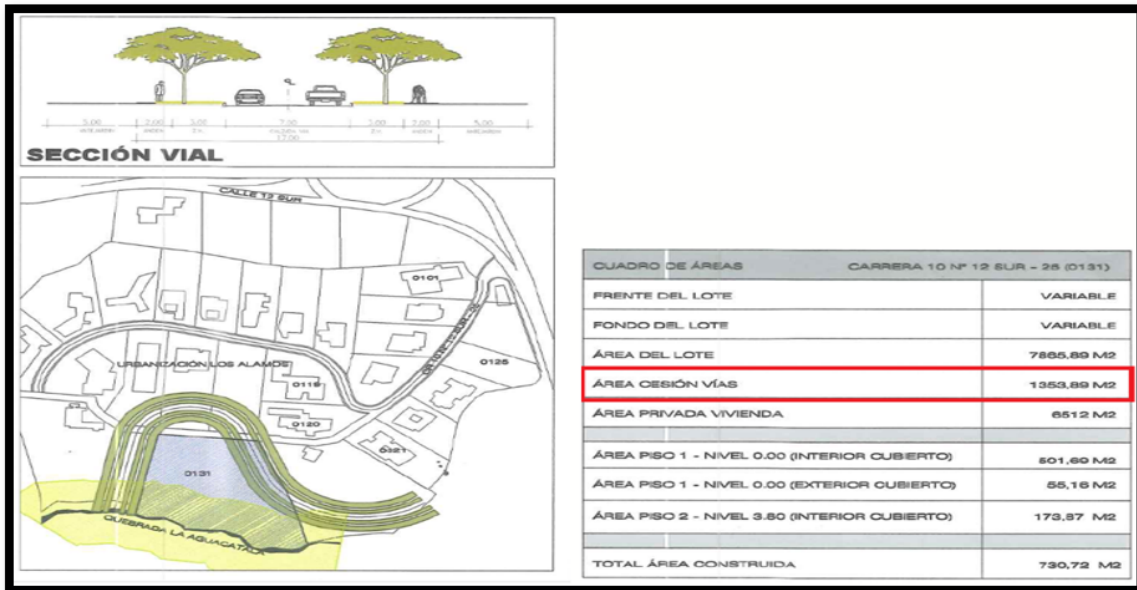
aparte de los planos de la licencia construcción con resolución C2-0398-13
